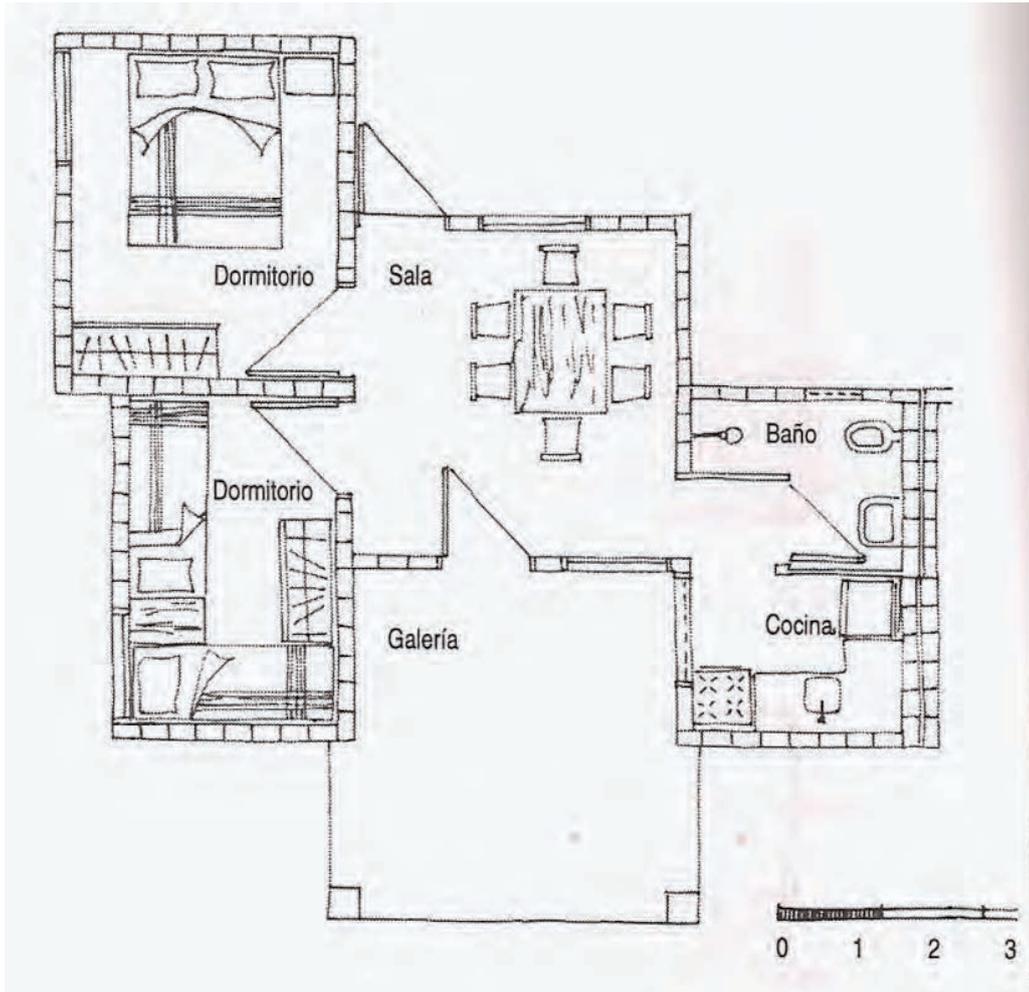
Plano de las viviendas en Limpio (Paraguay).
